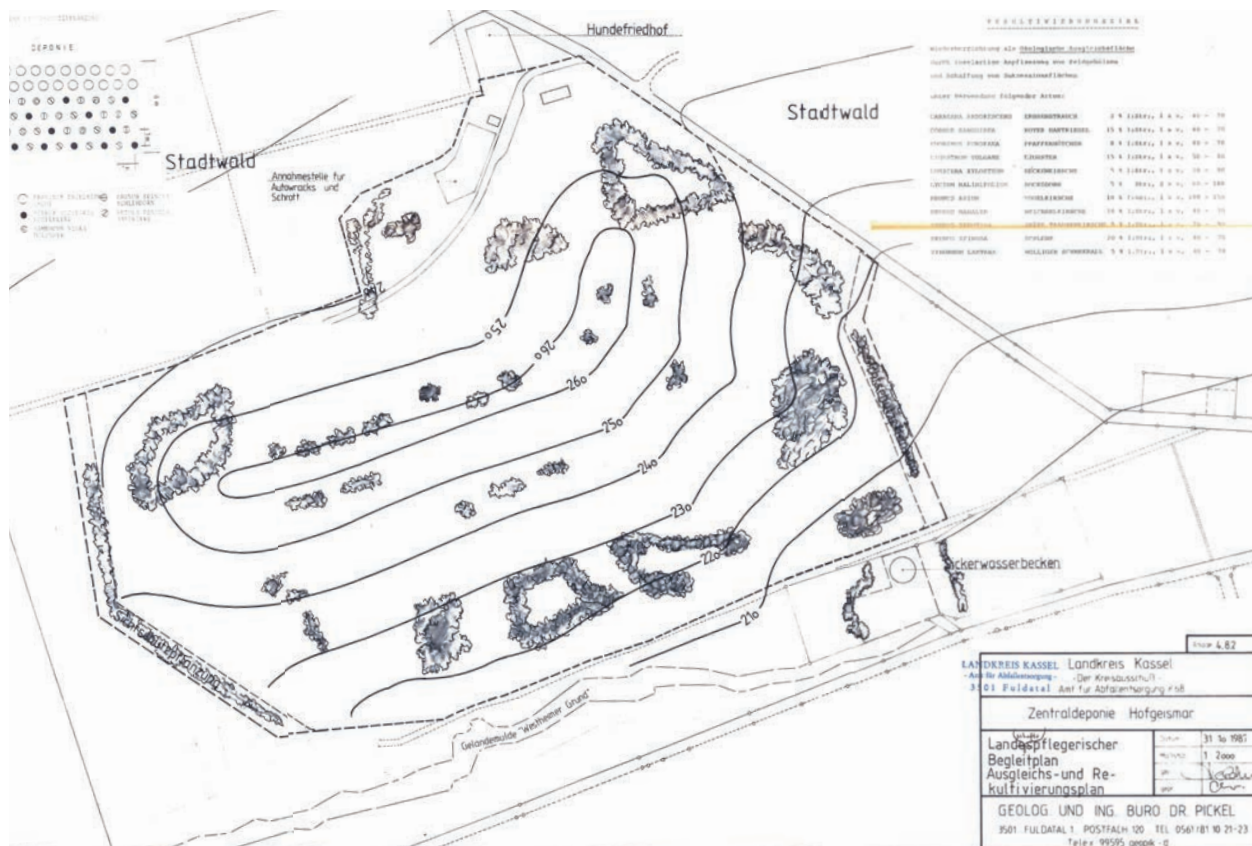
Landschaftspflegerischer Begleitplan Ausgleichs- und Rekultivierungsplan zum Planfeststellungsverfahren 1989, (Geolog. und Ing. Büro Dr. Pickel, 31.10.1987, ohne Maßstab)
